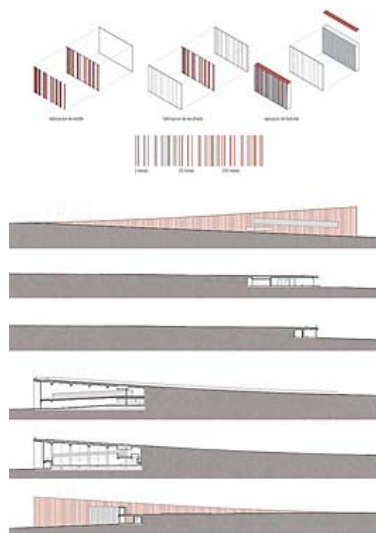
Arriba: proceso de fabricación de fachada Medio: fases de envejecimiento de la fachada. Abajo: secciones transversales en la intervención.
